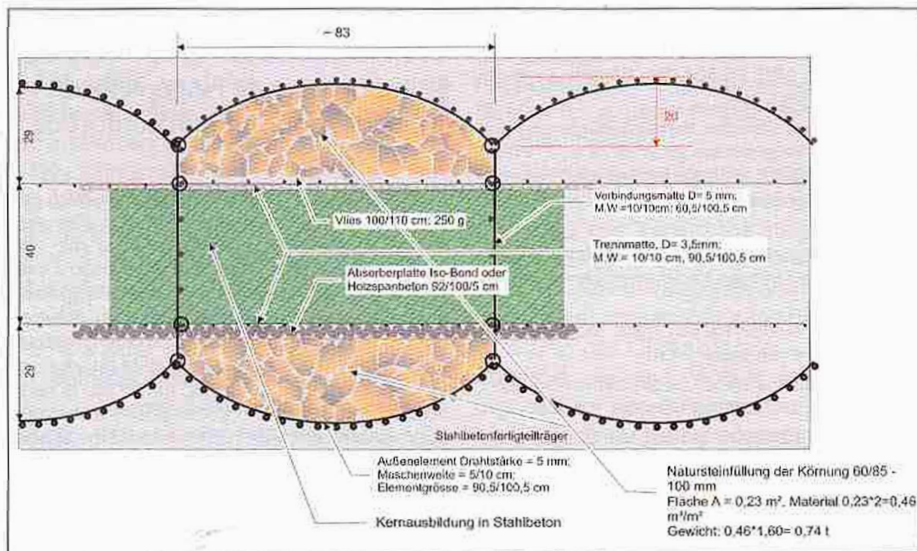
Grundriss des Ferrondo-Dreikammersystems
